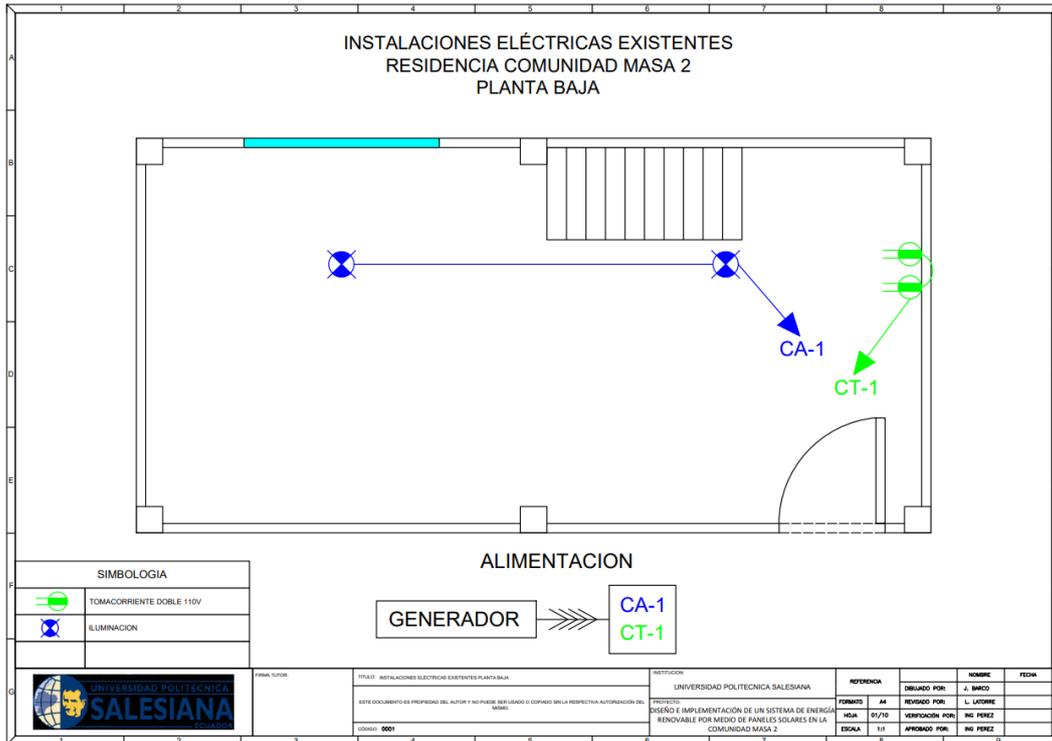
Instalaciones eléctricas existentes residencia comunidad Masa 2 planta baja
